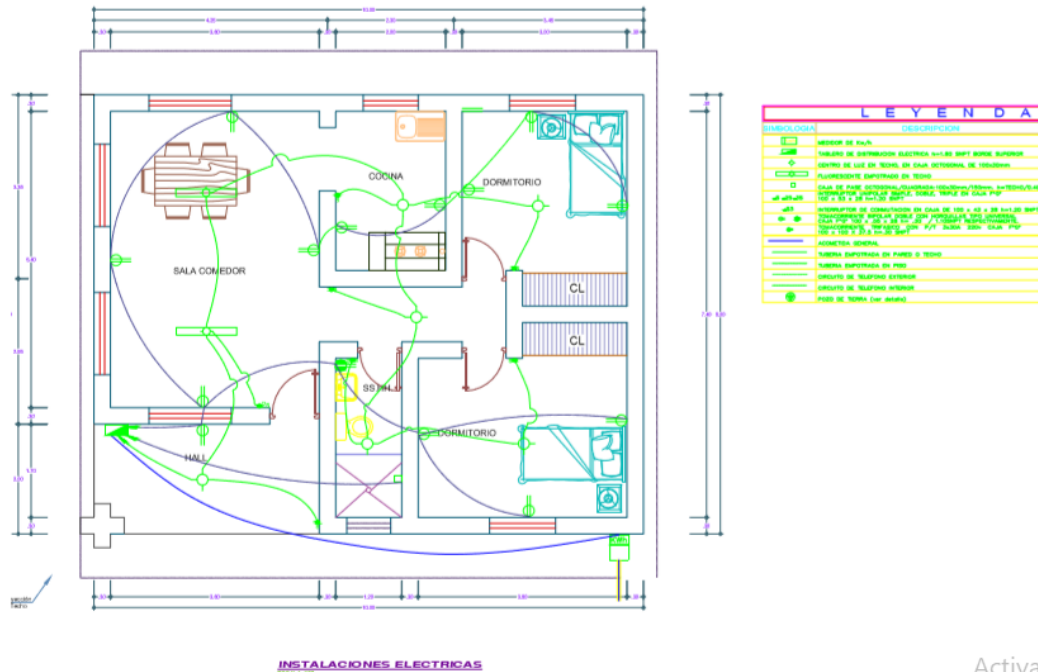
Plano de instalaciones eléctricas, Esc. 1/75
